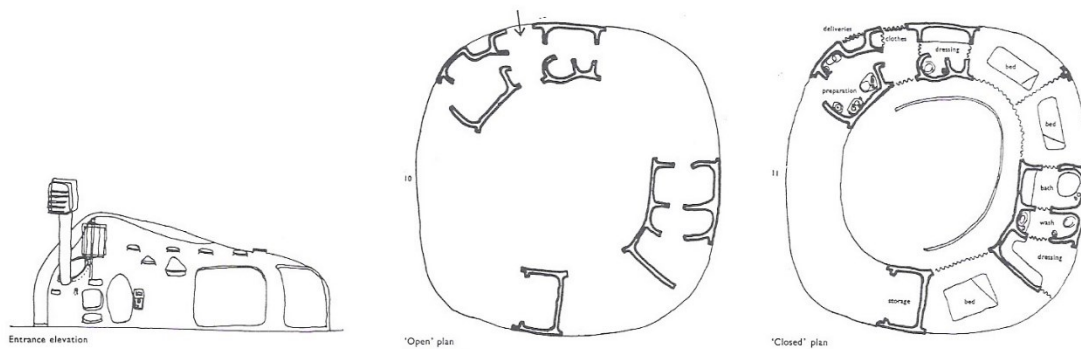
Casas Accesorio*, planta abierta y planta cerrada (1956-1958).
